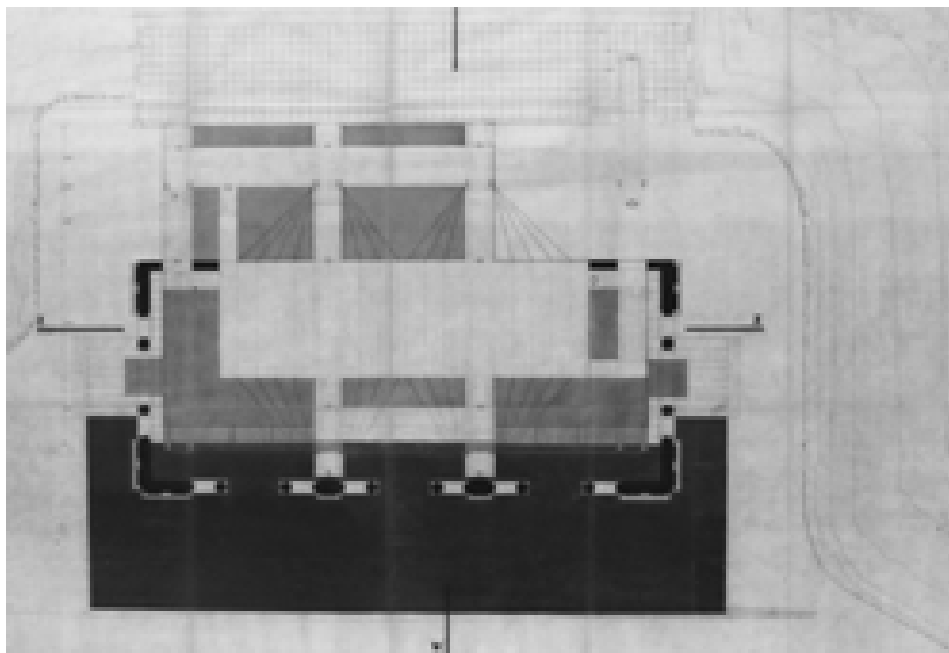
Pianta quota 4.20, progetto di massima, 1973/1974 (AABS-161)
